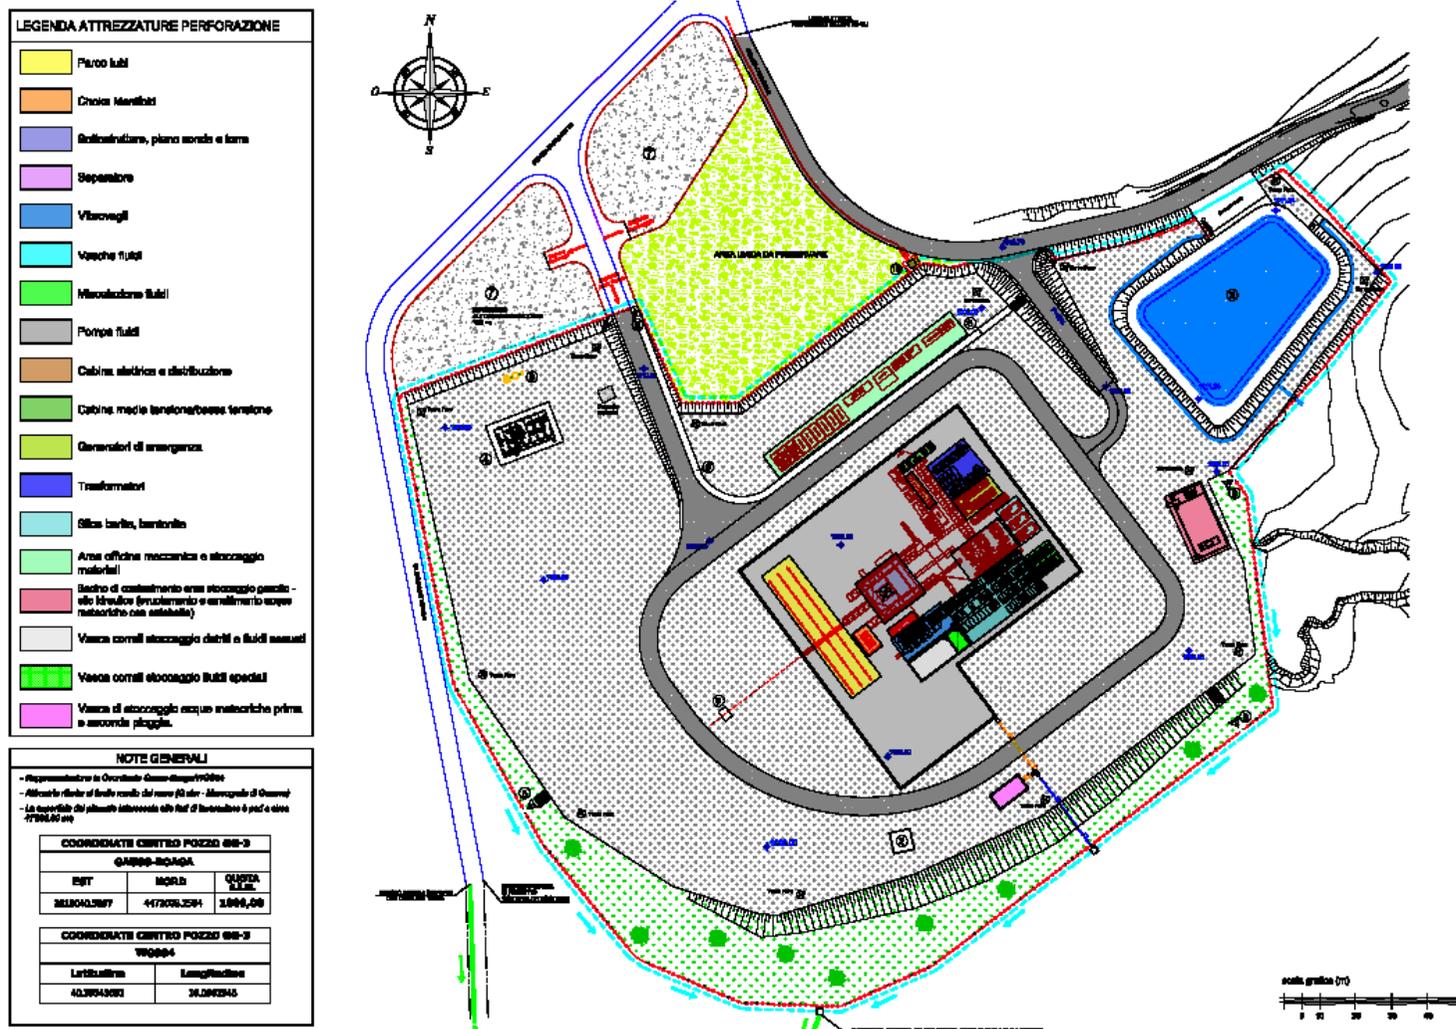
Lay-out piazzale GG3 - Fase Mineraria – Prove di produzione
